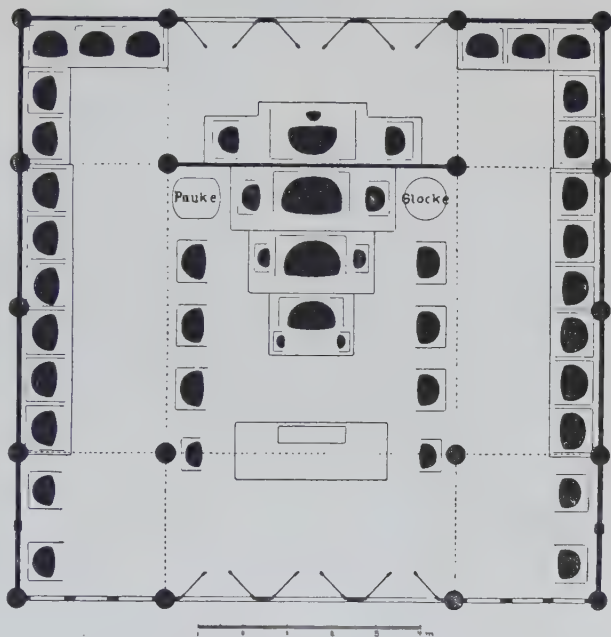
Grundriss des Tempels der drei Edelstein-Kaiser in Kiating-fu in Szech'uan.
